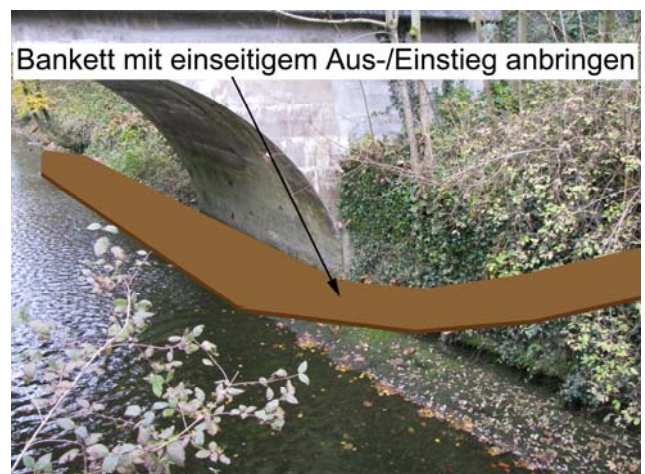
Gewässerdurchlass Unterwasserkanal bei der Strasse Burgschache – Obergadematt (Massnahme GD1)
